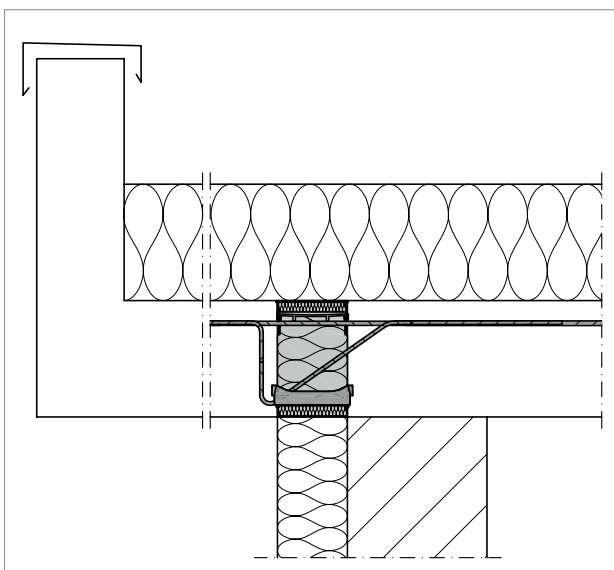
Schöck Isokorb® XT type K: Aansluiting bij enkelwandig metselwerk
